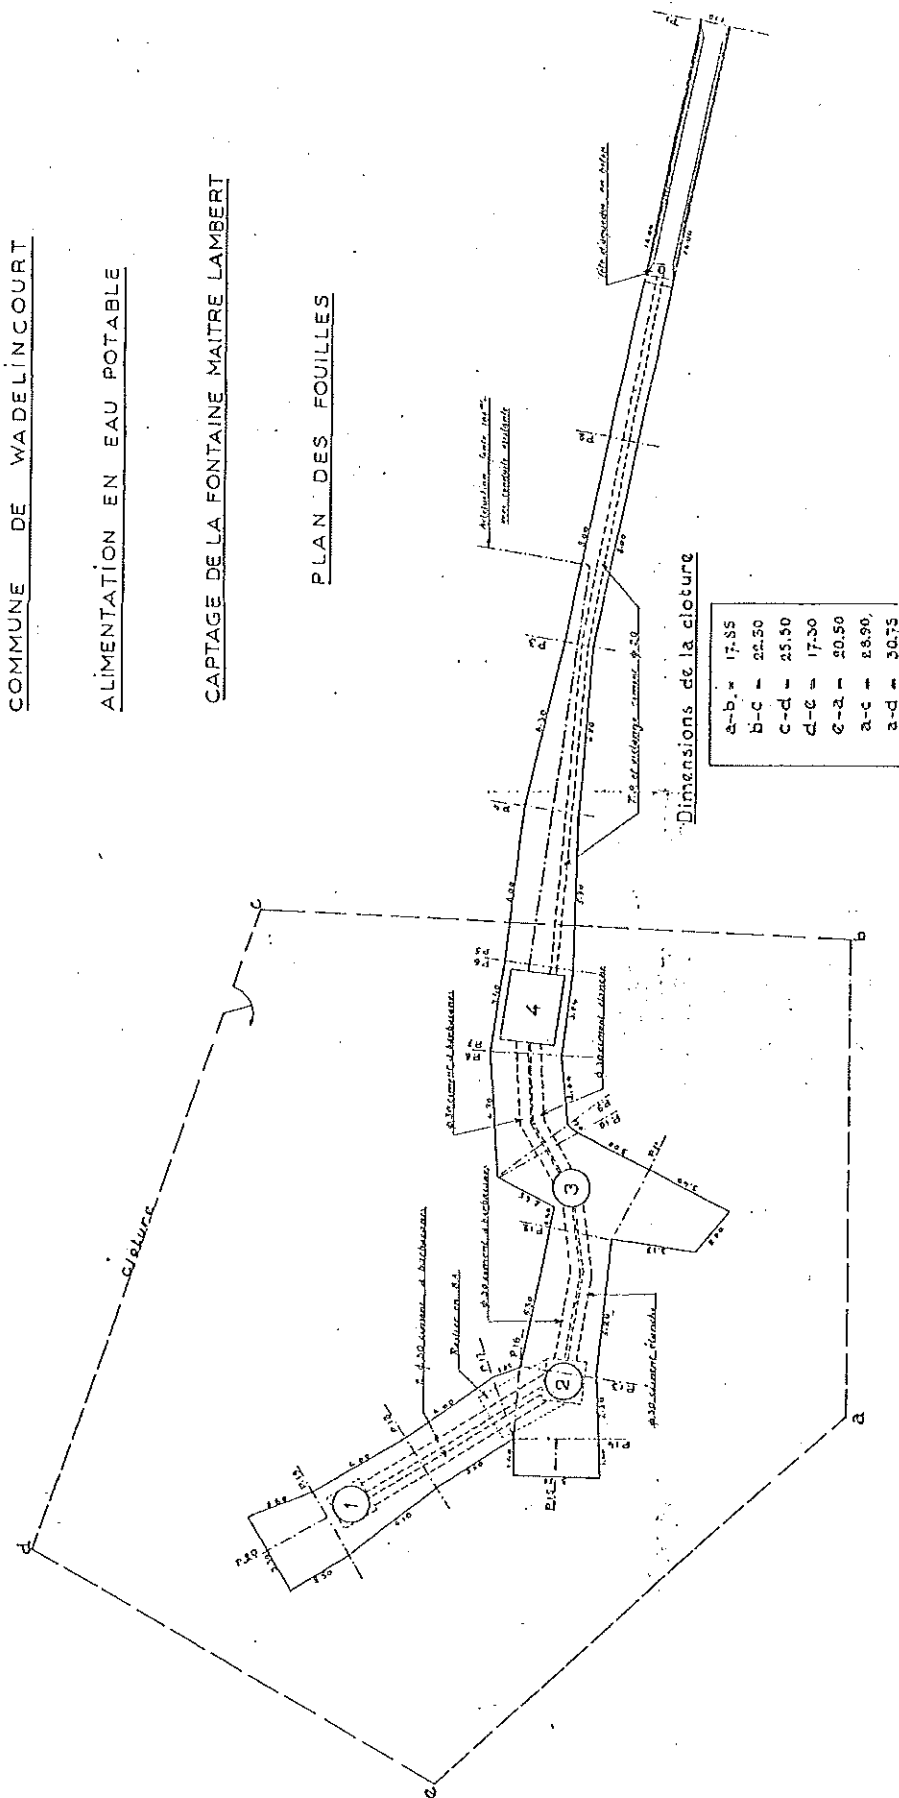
Plan des installations du captage de la «Fontaine Maitre Lambert»
